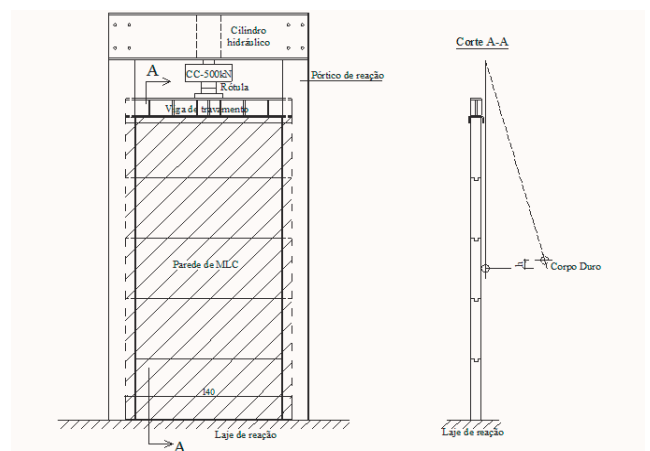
Instrumentação do ensaio de compressão simples da parede (dimensões em cm)
